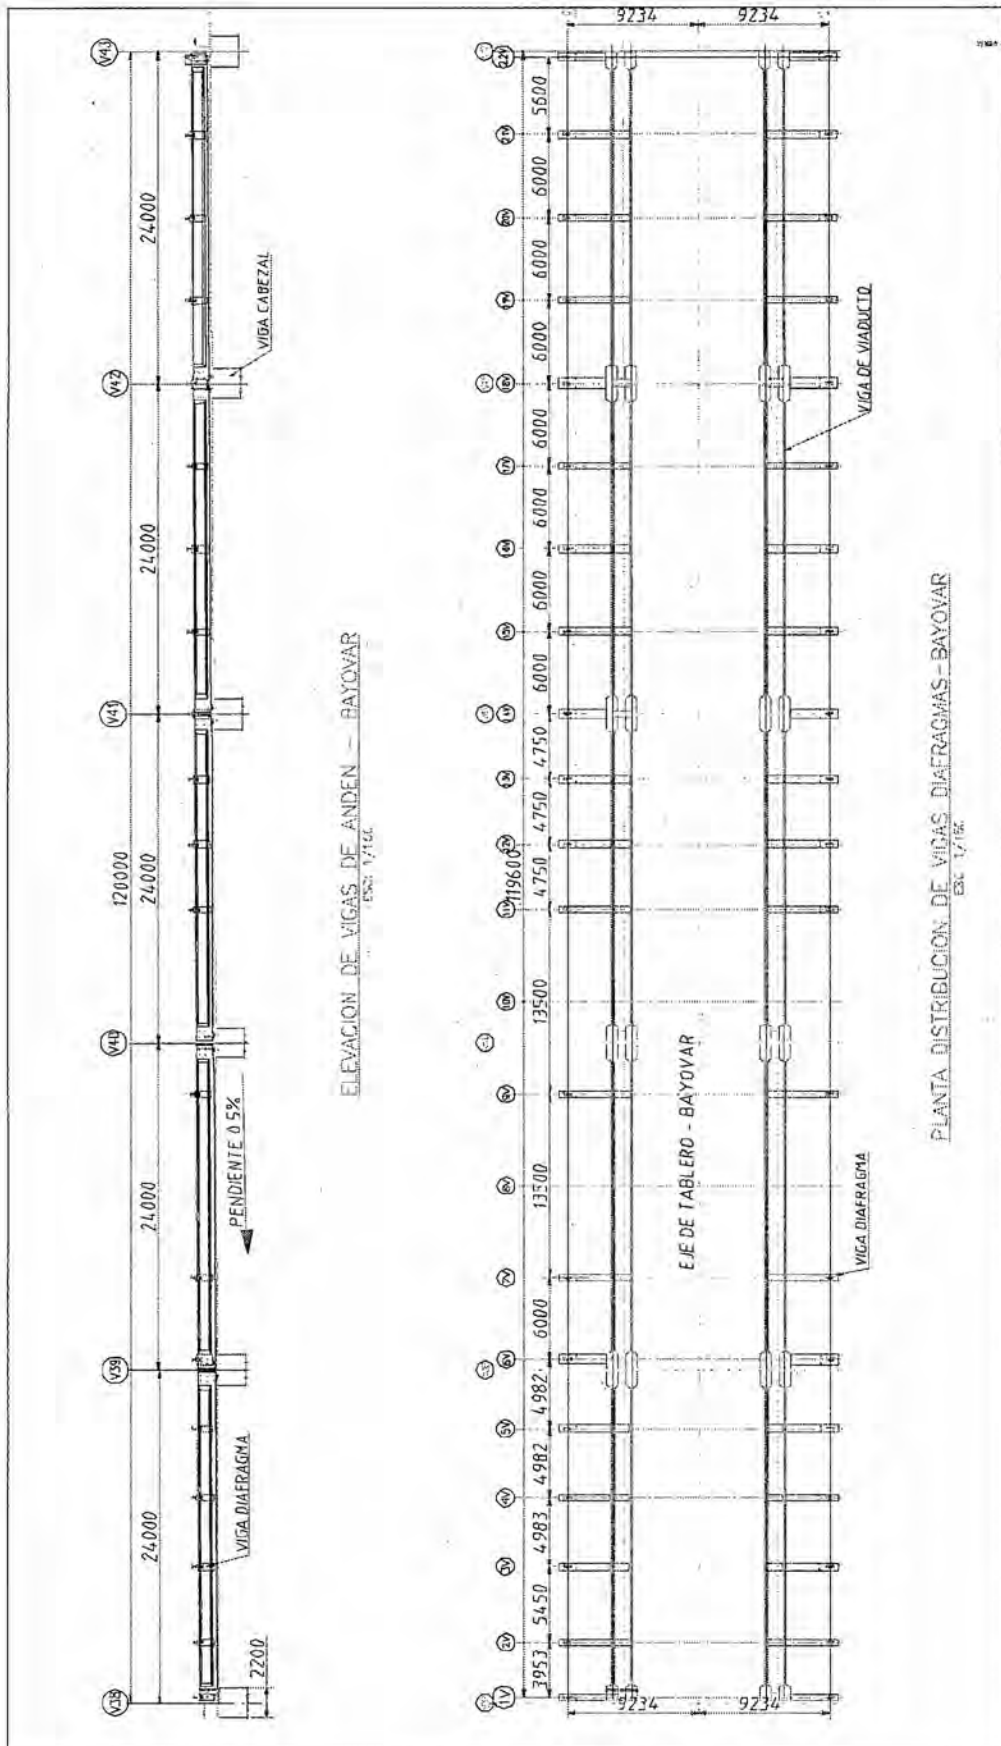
Distribución de Vigas Diafragmas (Fuente: Tramo 2)
